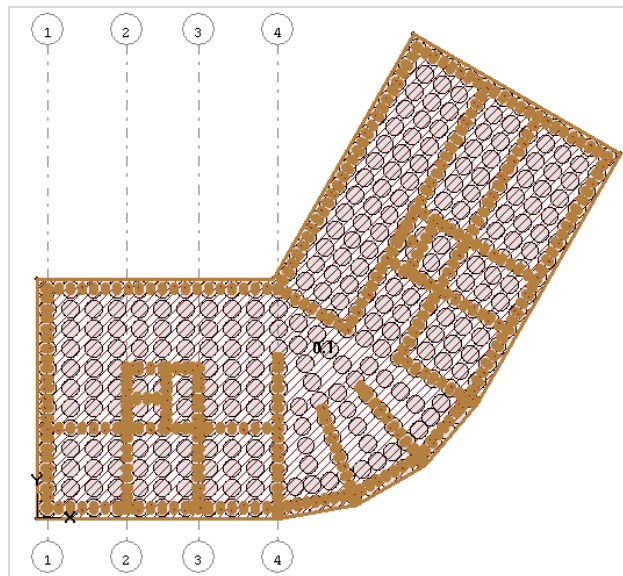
Фундаментная плита №1\_1 на свайном поле с нагрузками
